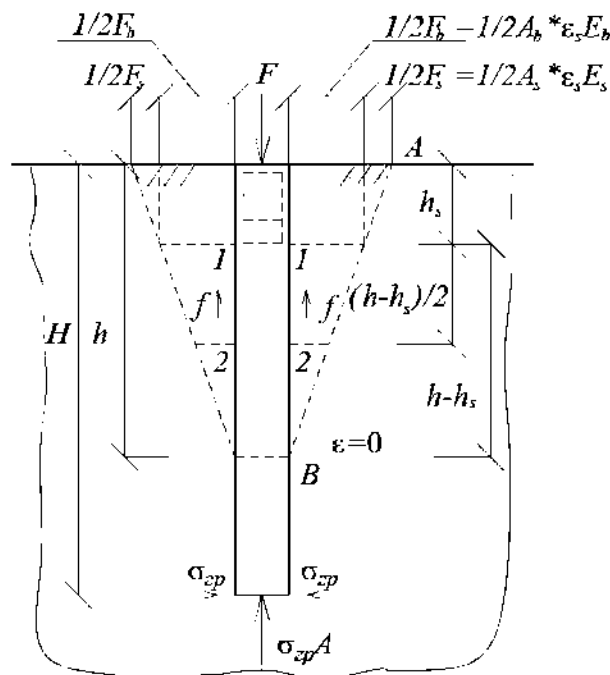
Распределение нагрузки F на материалы сваи и грунт основания фундамента
